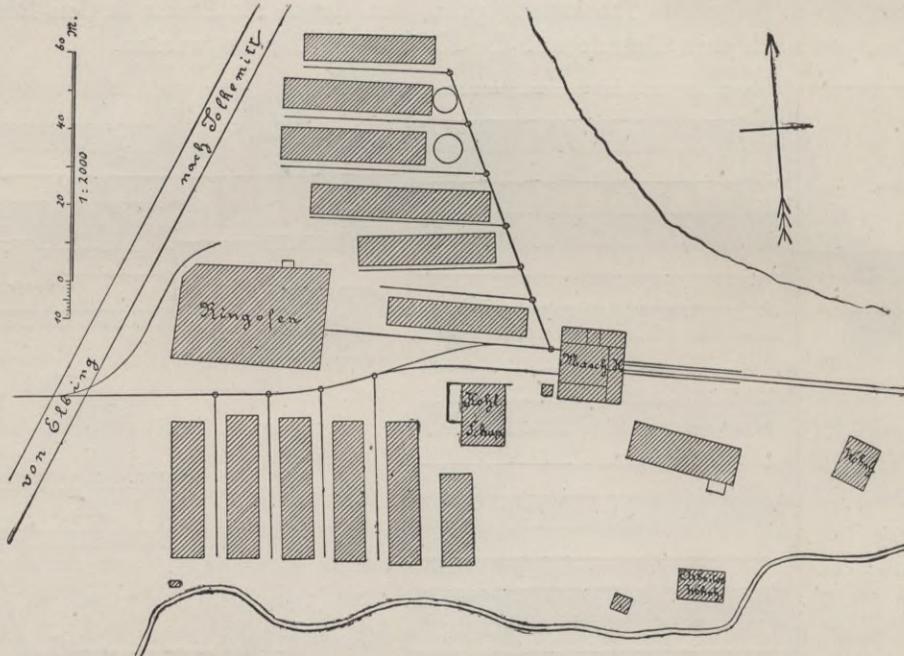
Lageplan der Kaiserlichen Ziegelei in Cadinen.
